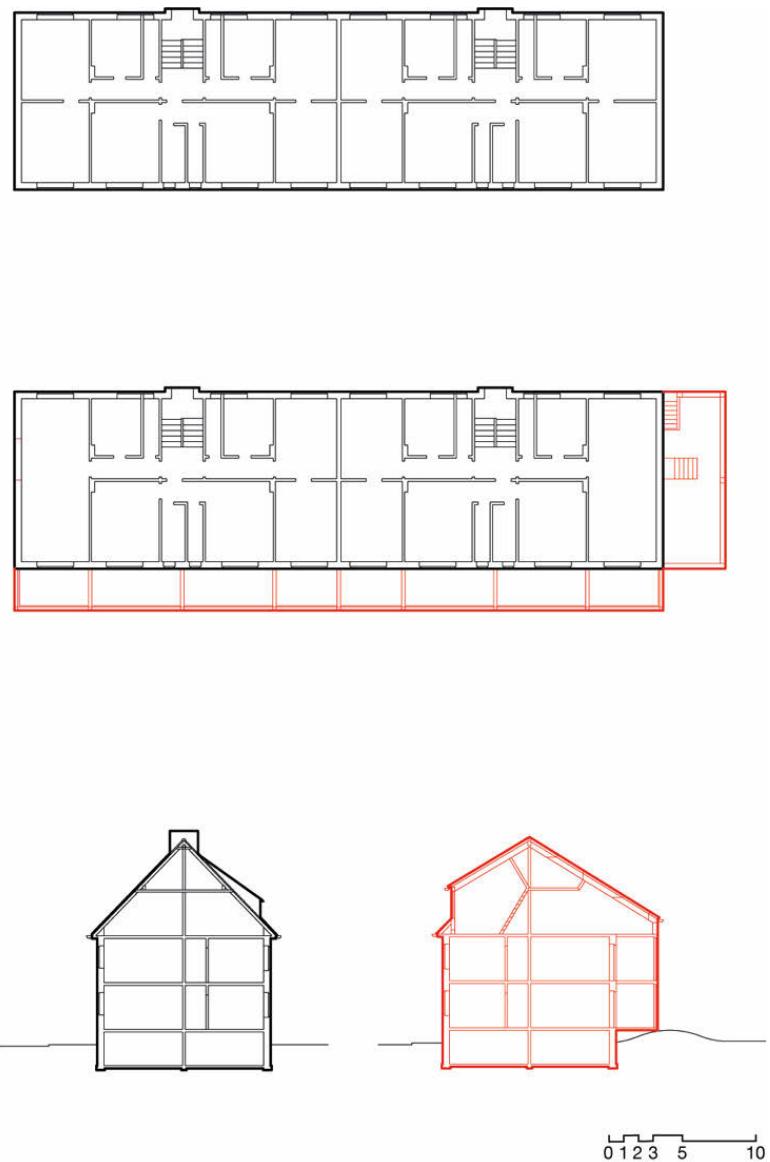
Grundrisse & Schnitte Bestand – Aufstockung, Bergedorf
